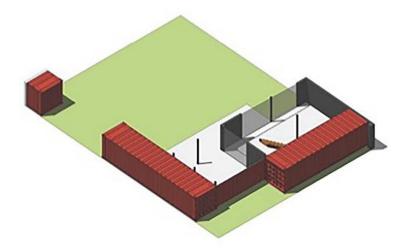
Fachada - Casa José Schreiber Arquitecto.
